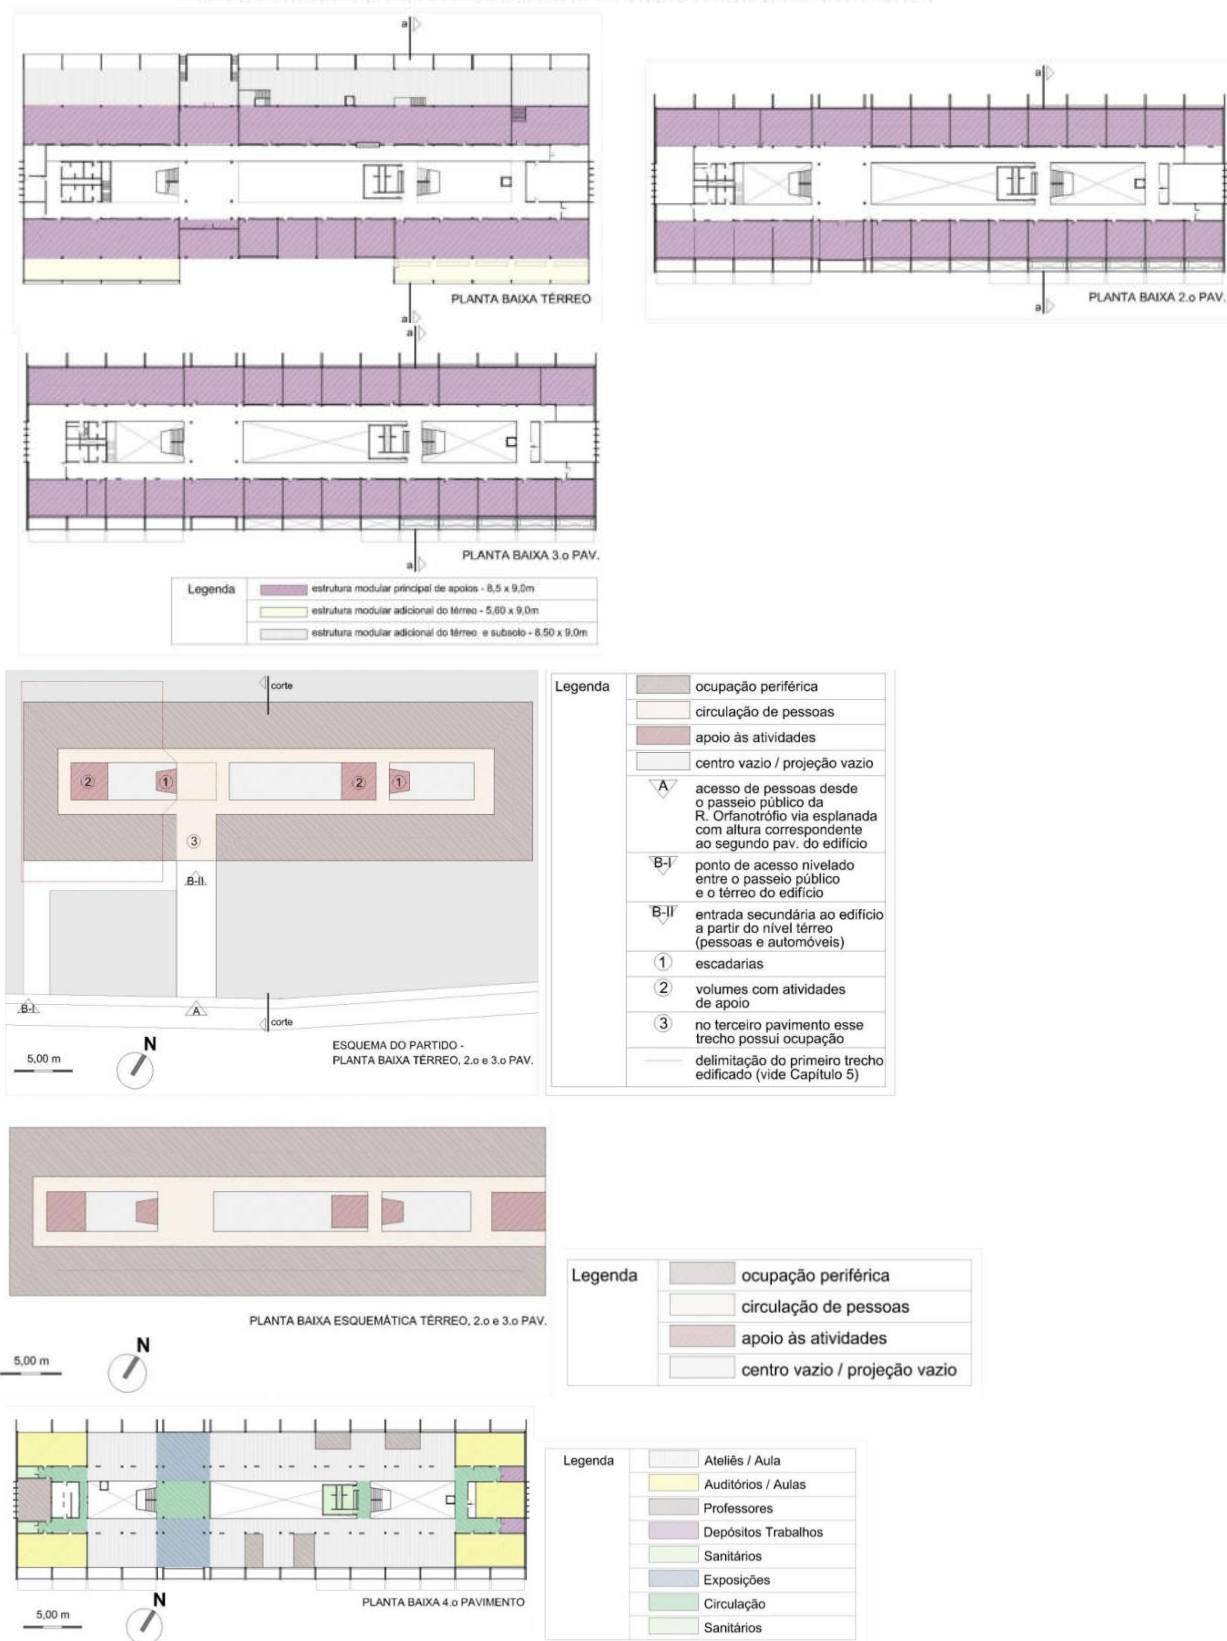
Primeira linha à esquerda: Planta baixa térreo.
